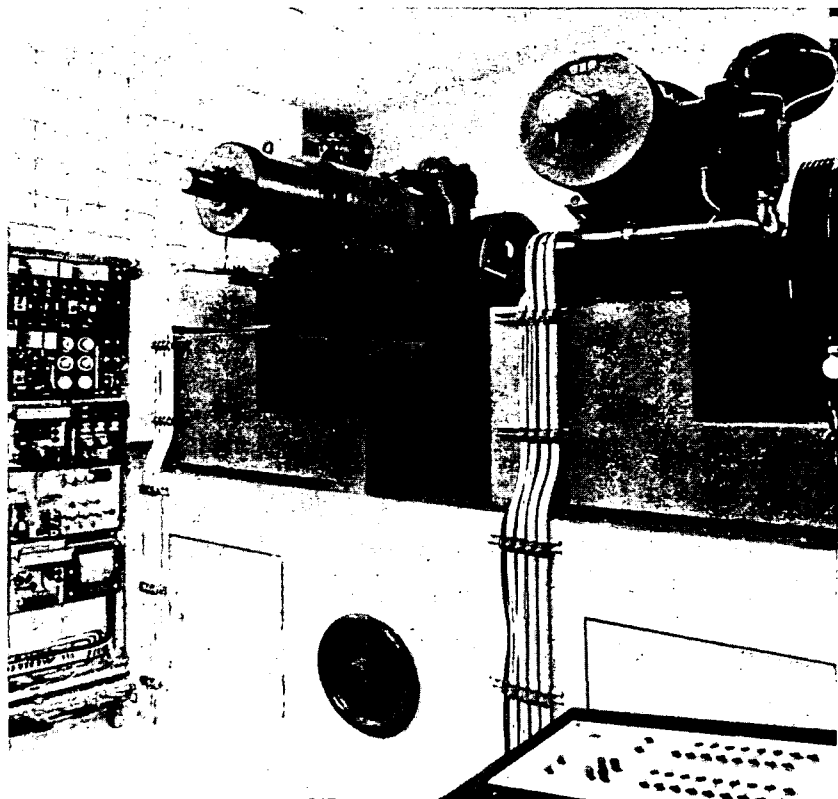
Лебедки, опирающиеся на тяжелый бетонный блок
